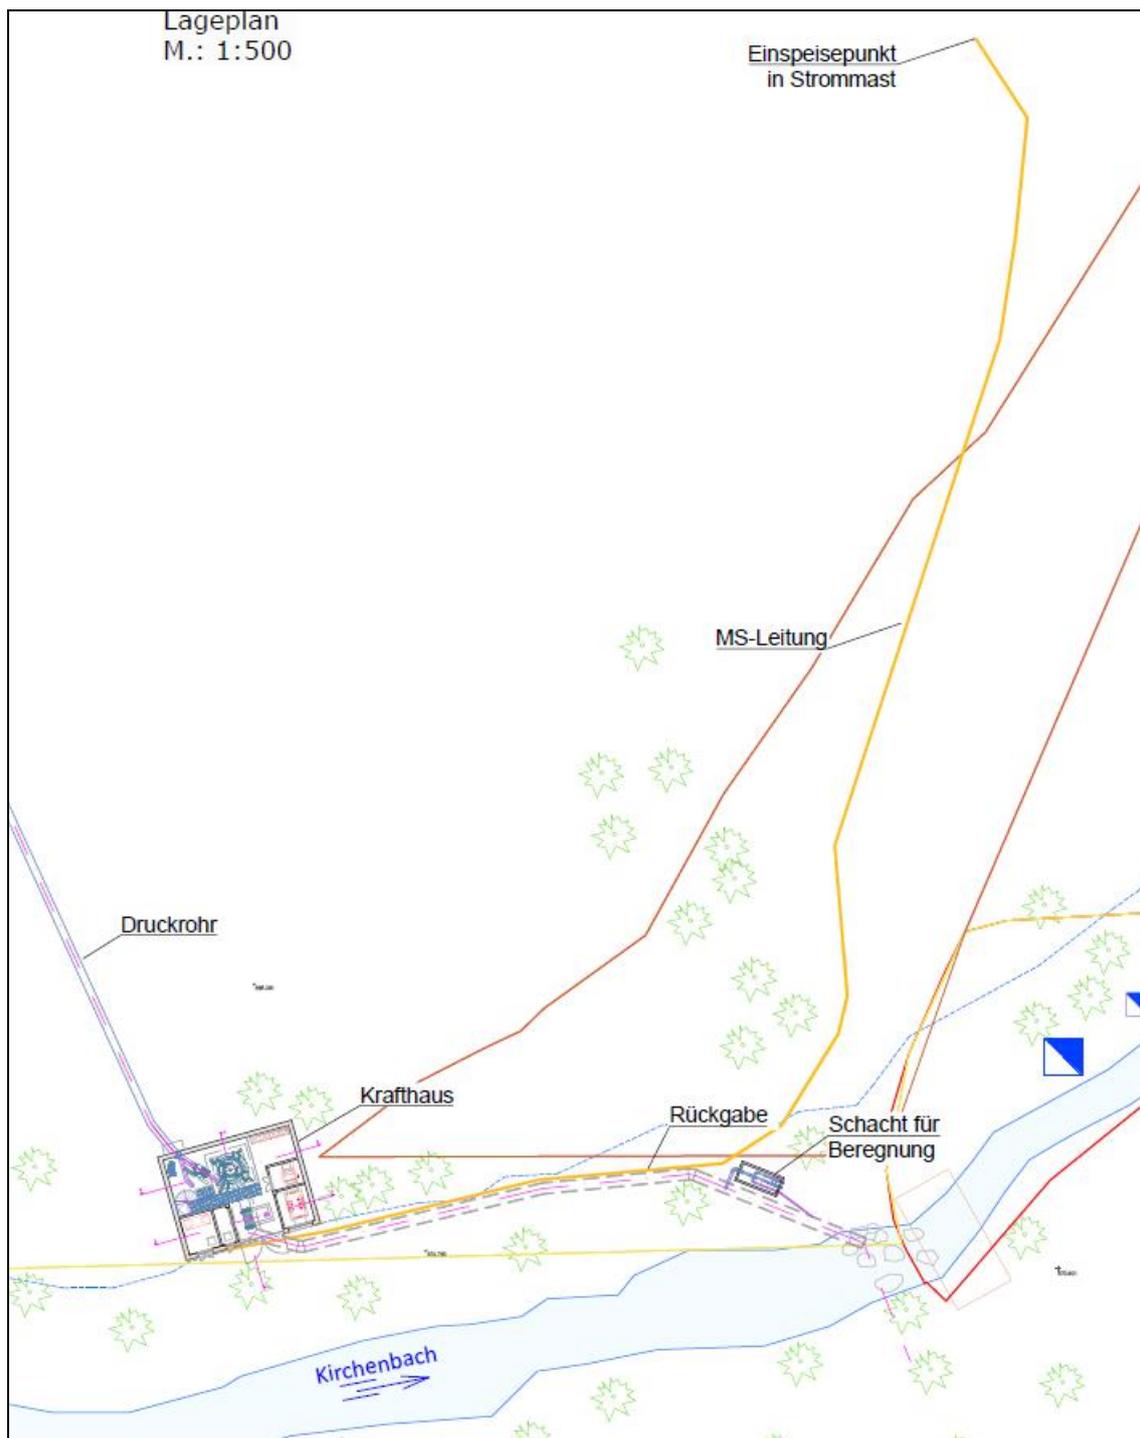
Planimetria di progetto: centrale e restituzione (fonte: Tavole progettuali)
